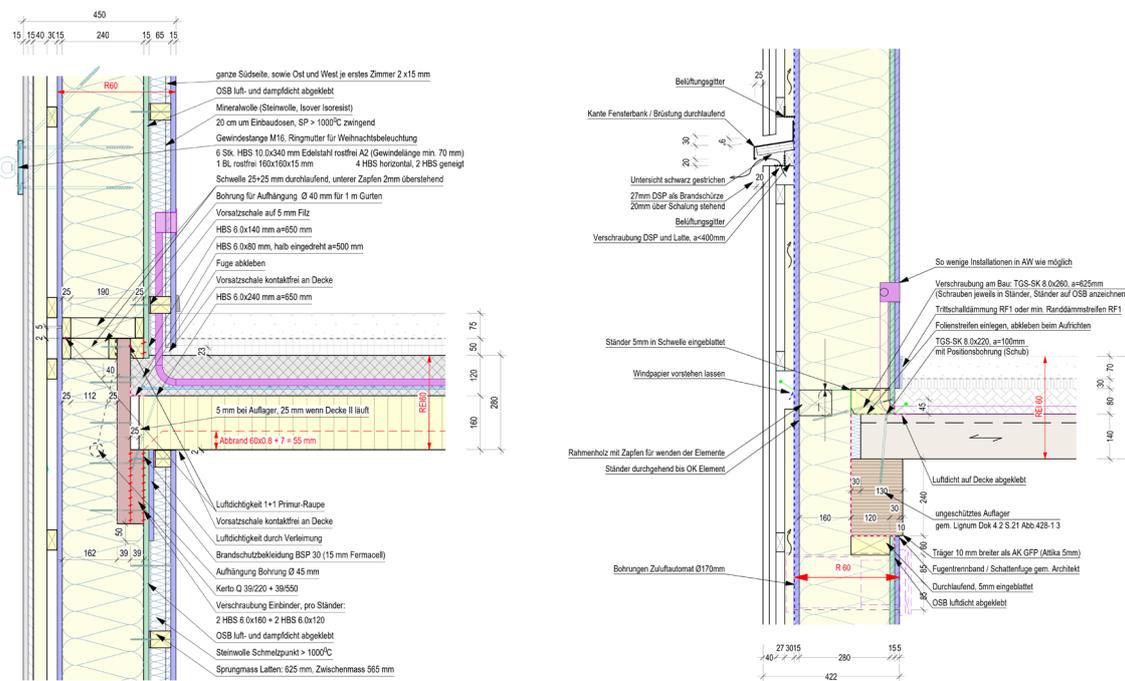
Aussenwandaufbauten und Anschlussdetails Holzrahmenbauweise (links: mit Vorsatzschale, Furnierschichtholzeinbinder; rechts: ohne Vorsatzschale, Brettchichtholzeinbinder)
